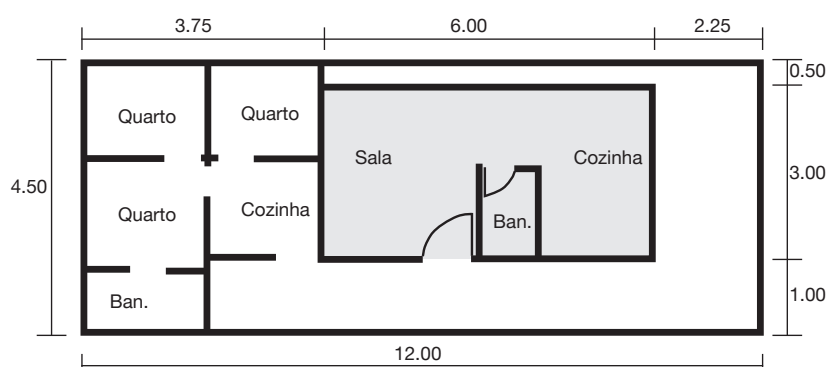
PLANTA BAIXA DA CASA DE MAURÍLIO
